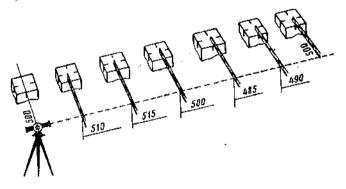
Схема выверки осей фундамента с применением нивелирной рейки Пример исполнительной схемы на монтаж фундаментов приведен на рис. 5.5.
